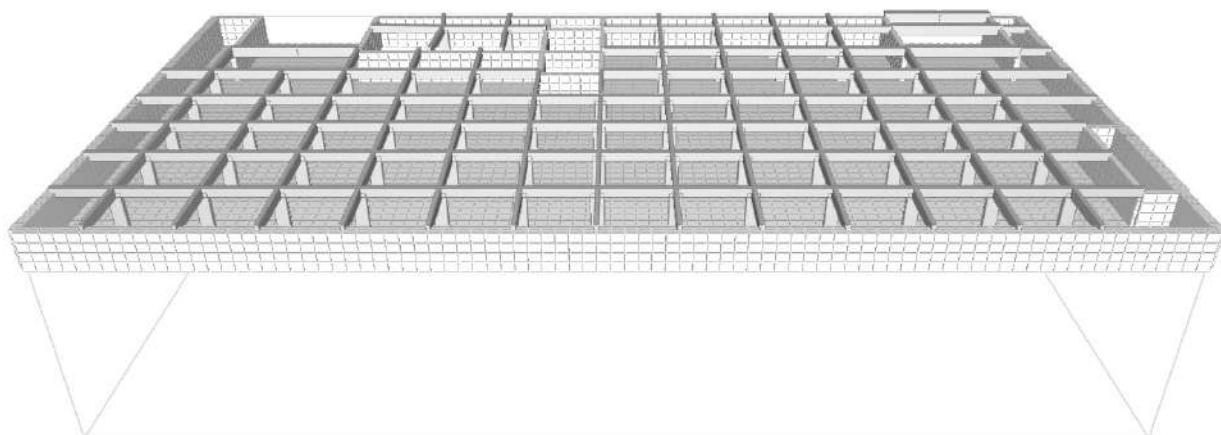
Modelo de cálculo da estrutura. Piso intermédio. Laje inferior à cota (46.90)
